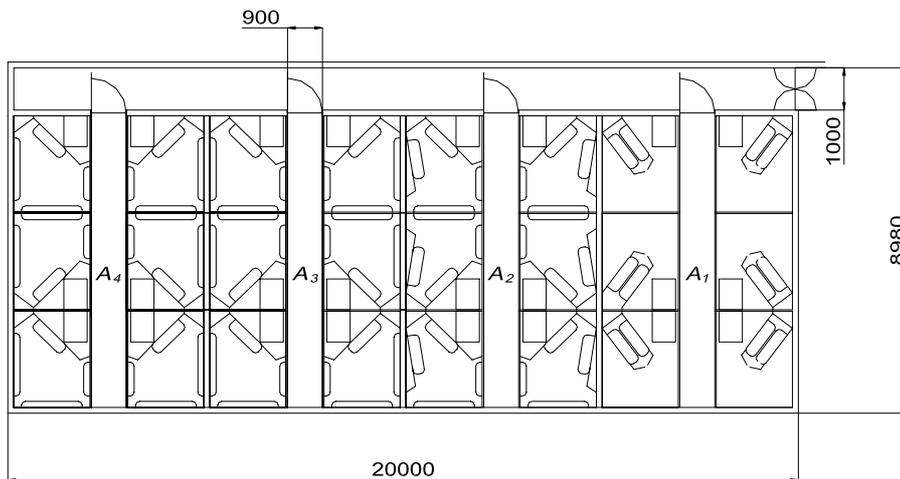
Grundriss des Abferkelbereichs (Maßangaben in mm).
